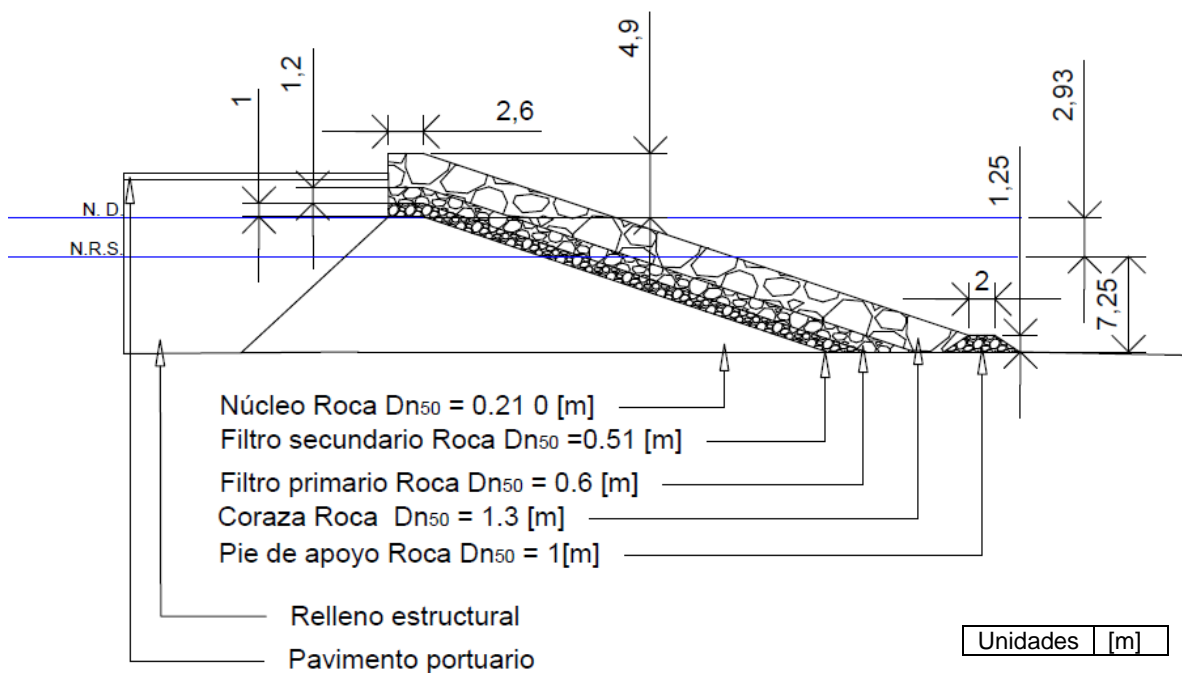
PLANO PERFIL DE ESCOLLERA FUENTE: ELABORACIÓN PROPIA
